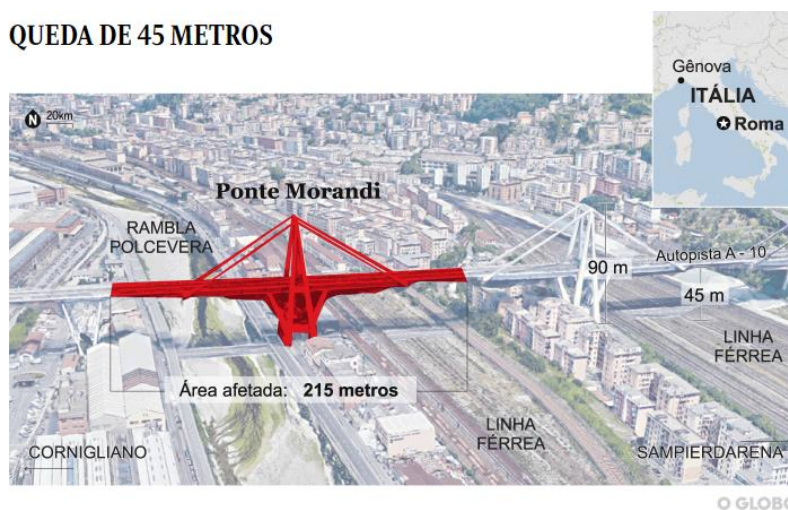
Ilustração em vermelho do trecho que desabou. (a)
